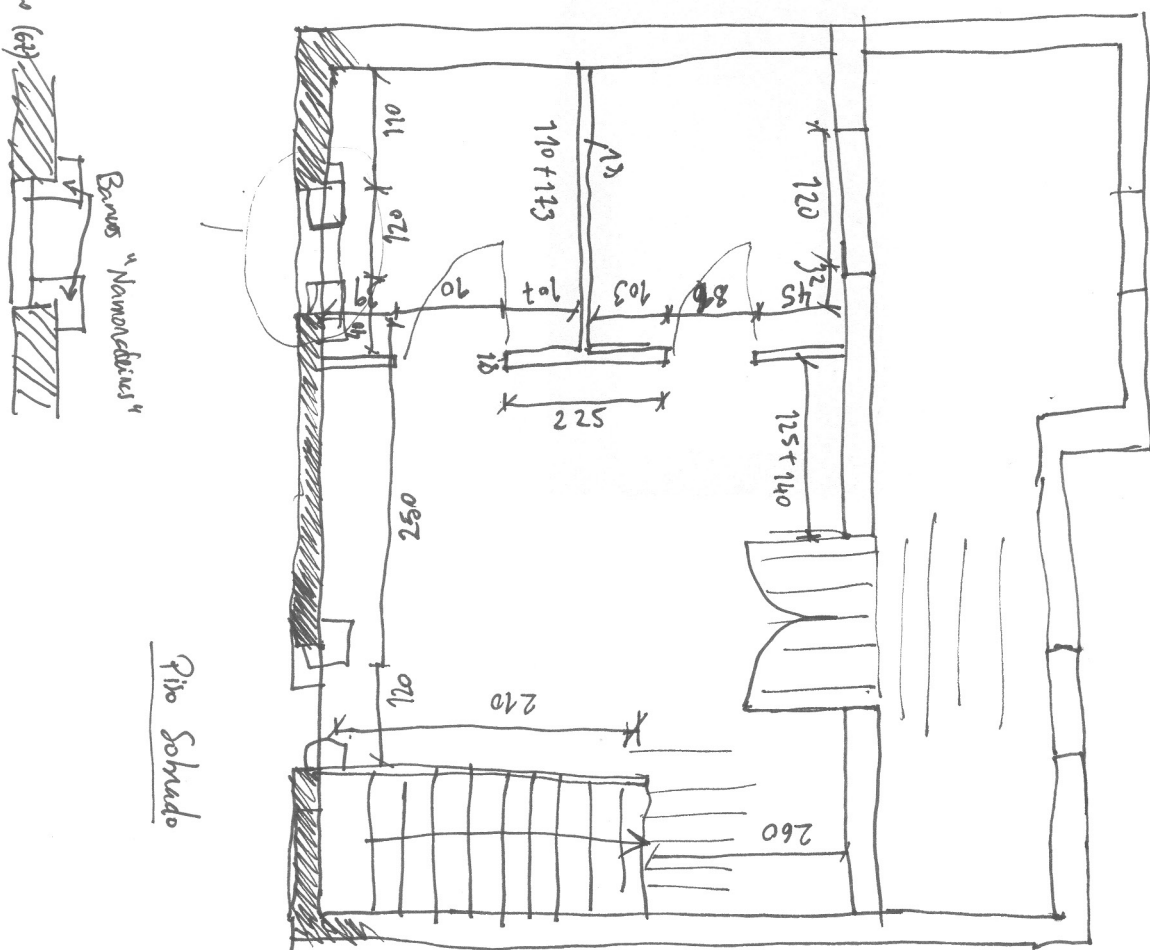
(acima) Planta de levantamento. Casa Bloco [AlbVelha5] , pág. 97
